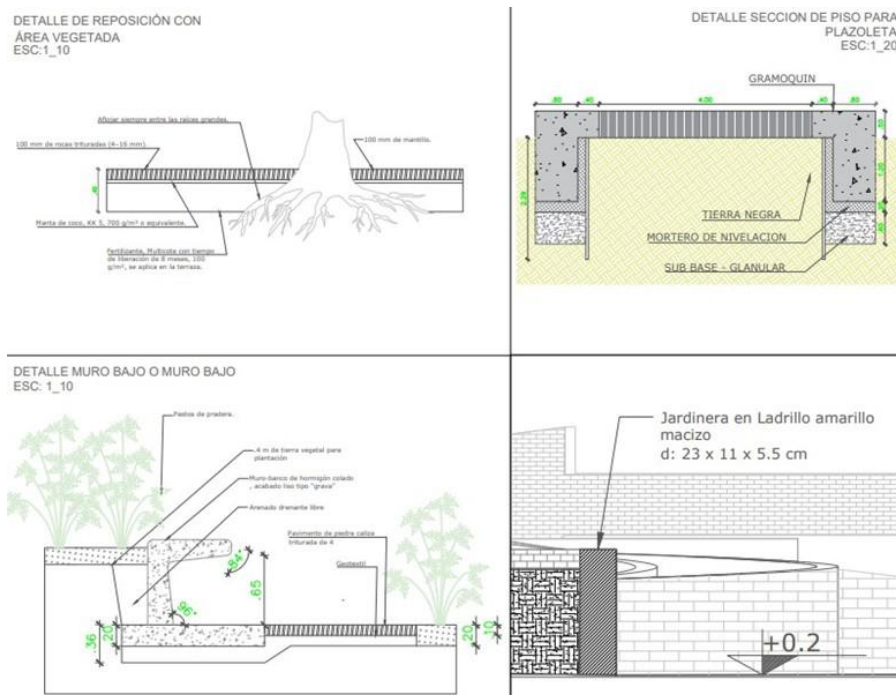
Plano ampliación muro jardineraFigura 17. Plano ampliación senderos
